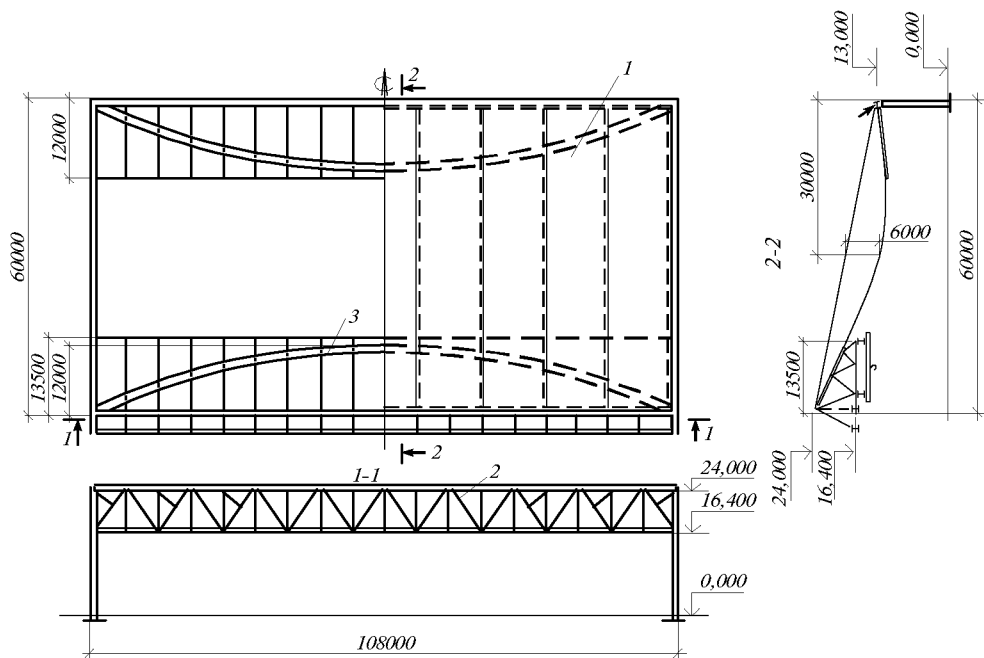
Мембранное покрытие ангара с подвесным крановым оборудованием
